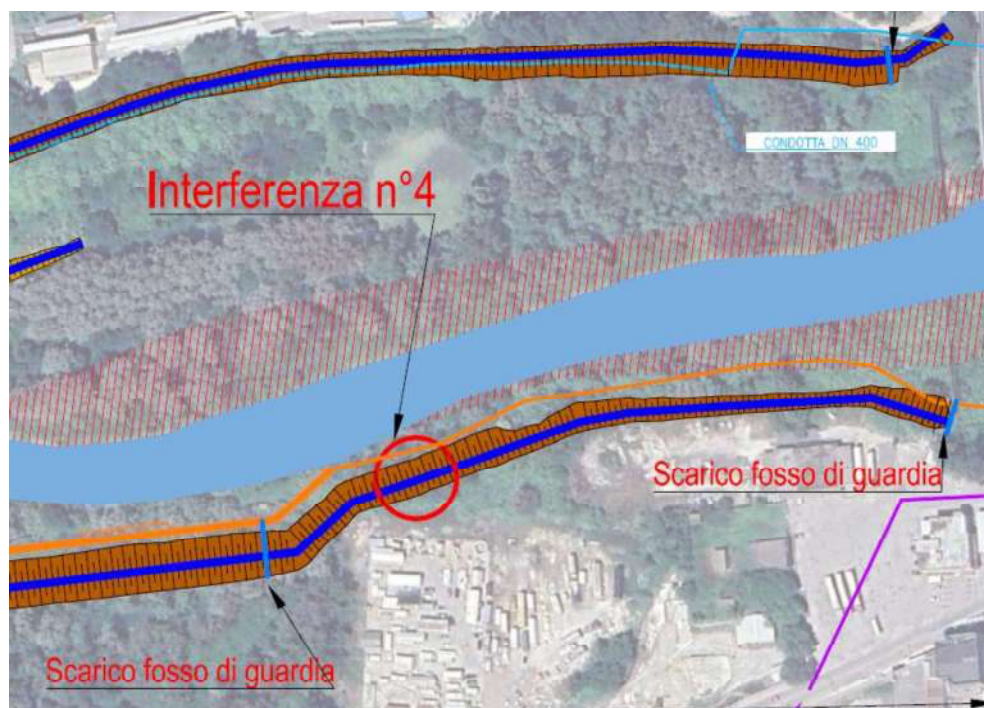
Stralcio planimetrico con ubicazione dell'interferenza tra l'argine di progetto e lo scatolare per alloggiamento del collettore a servizio di strada Parco - via Verrotti e zone limitrofe
